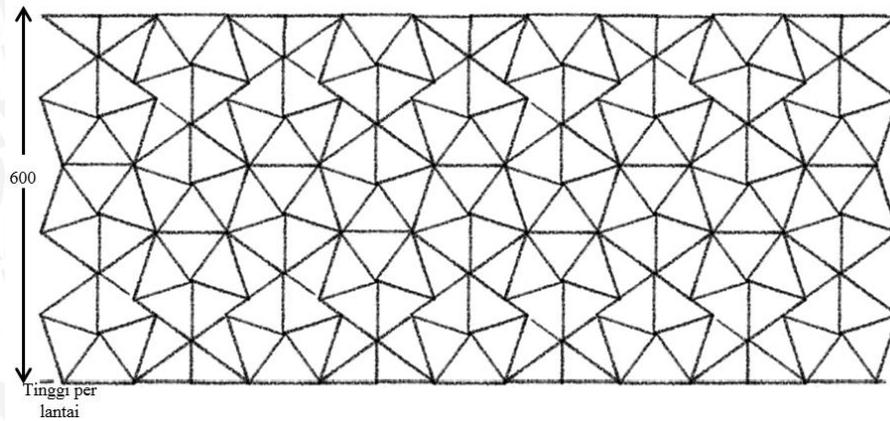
Alternatif dimensi panel 2 (100cm)
